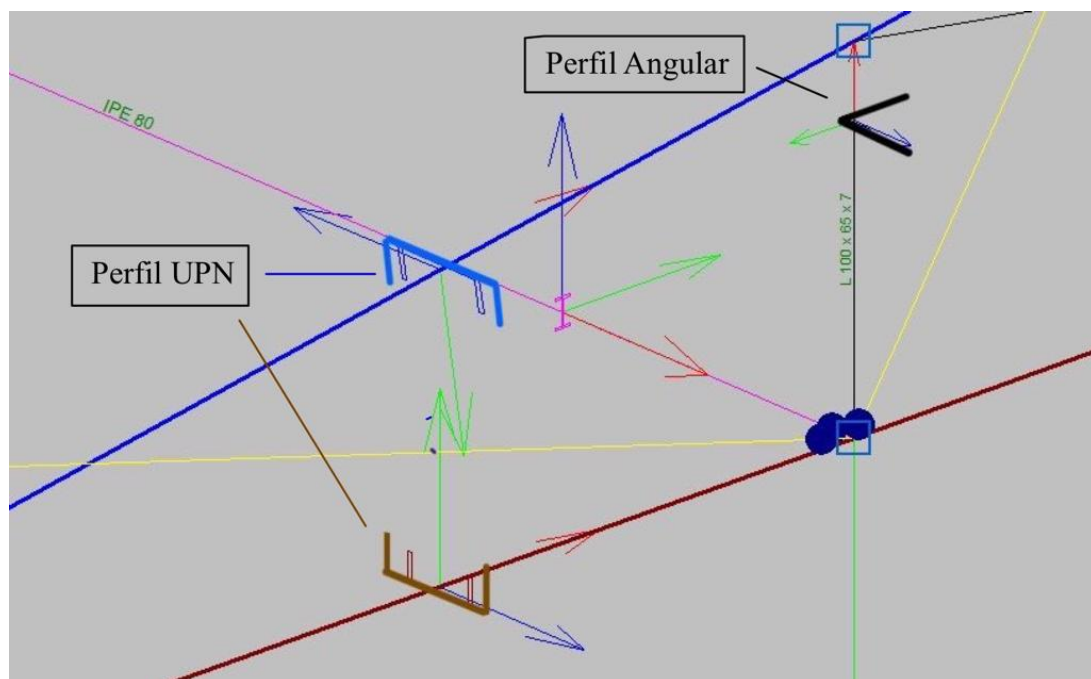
“Detalle perfiles de la celosía. CYPE 3D. Fuente: Propia.”
